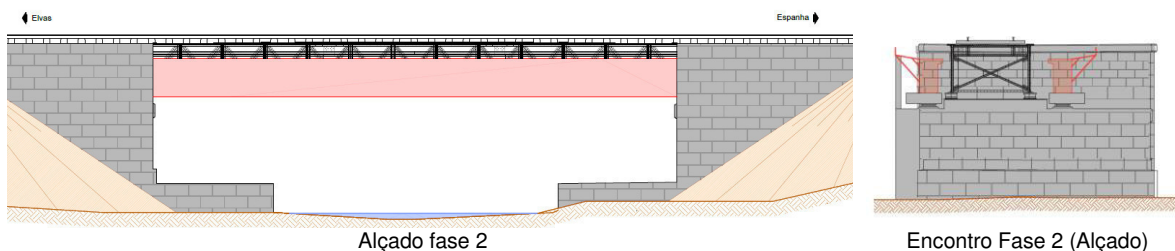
Colocação de vigas na ponte do Caiola [42]
